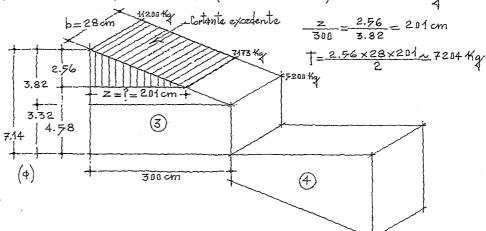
Valor dal, cortaute excedente, (4),(3)
